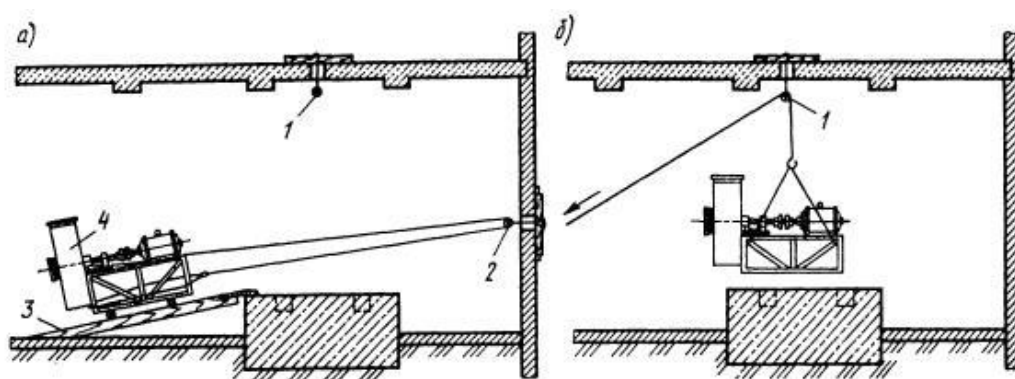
Підйом вентилятора (димососа) на фундамент;
